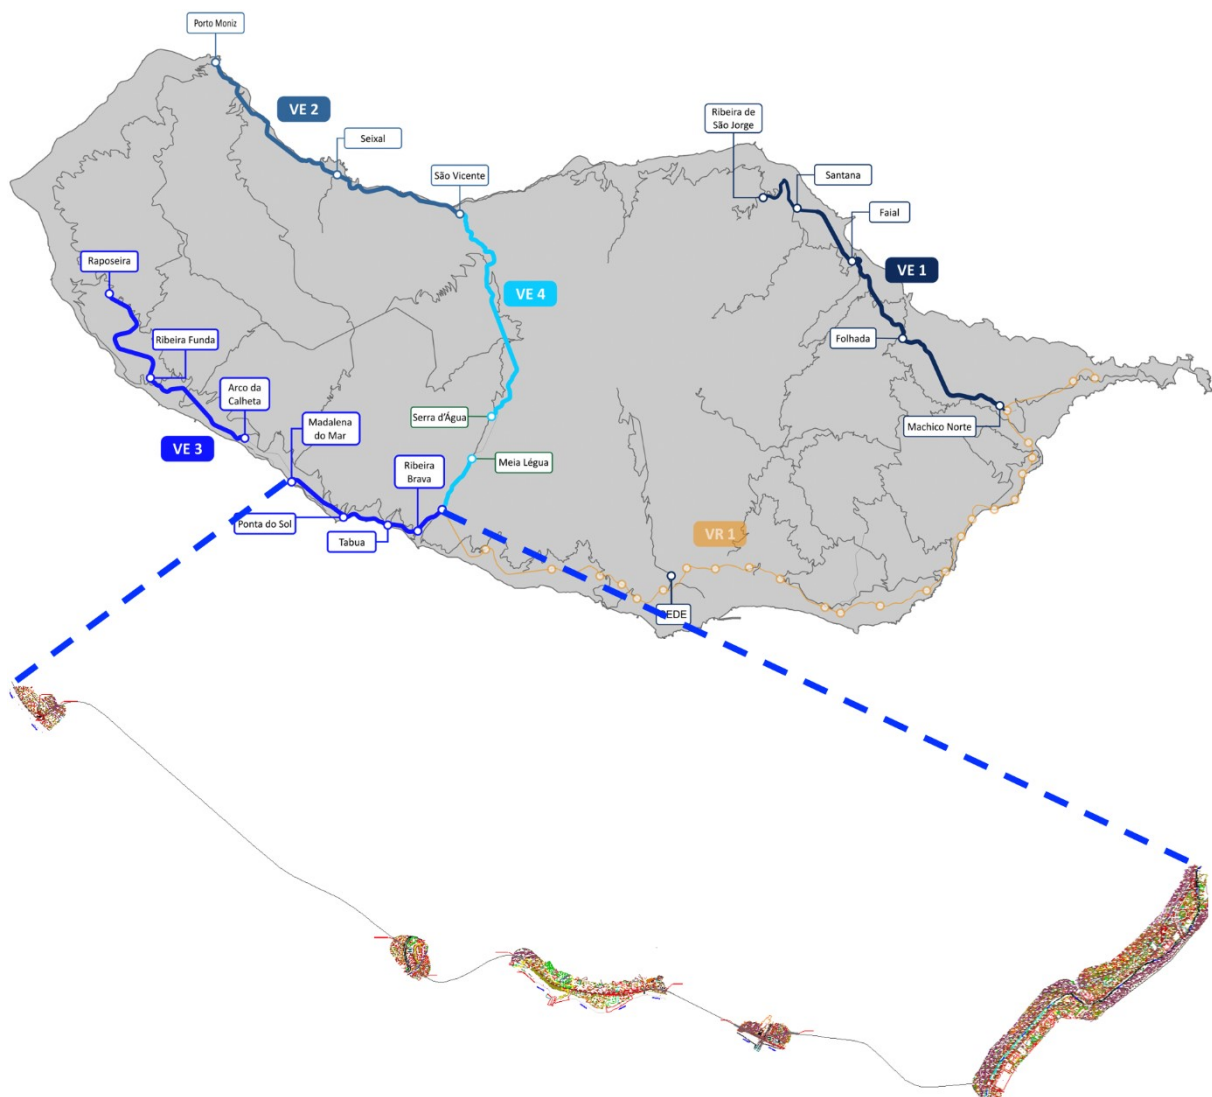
Localização do lança Ribeira Brava, Rotunda da Ponta do Sol e Rotunda da Madalena
